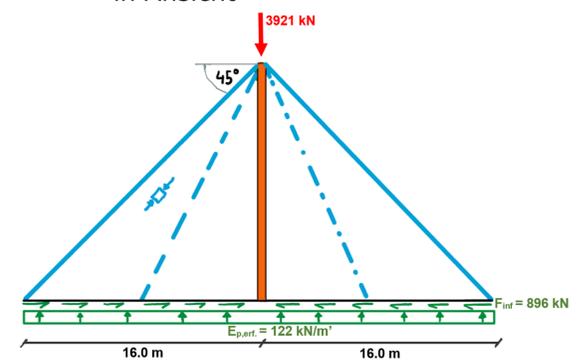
Lastausbreitung in der Einstellhallendecke mit Spannungsfeldern: Variante 2
